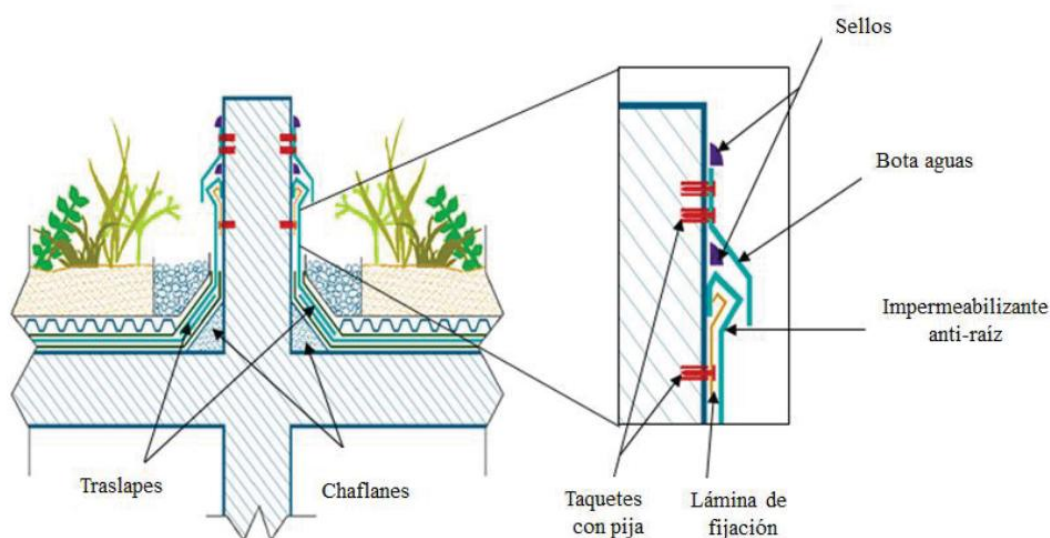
Impermeabilización con láminas de PVC, Propileno-Etileno o similares en puntos de encuentro con elementos emergentes intermedios.
